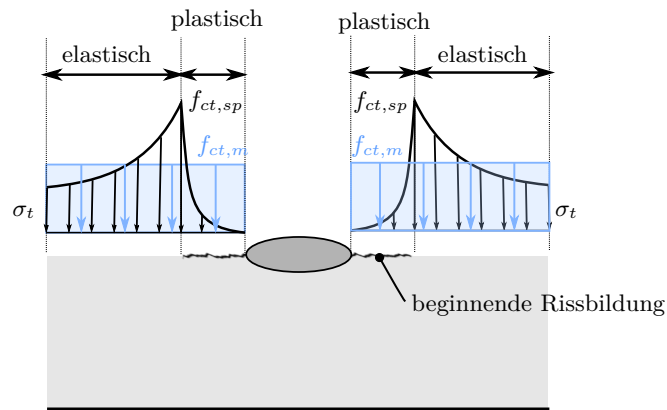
Betonzugbeanspruchung in der Ebene der textilen Bewehrung
